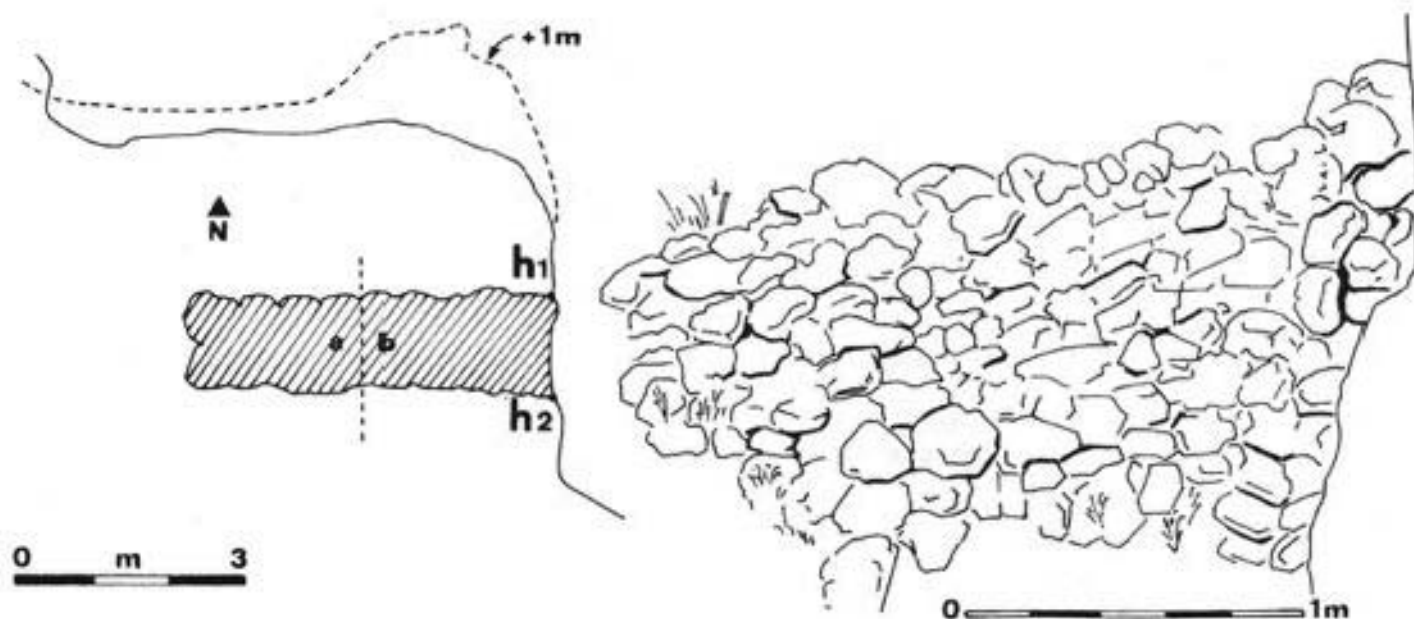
Plan de l'abri n°9 (a calcaire gris, b calcaire rose) et façade du mur d'après photo.
